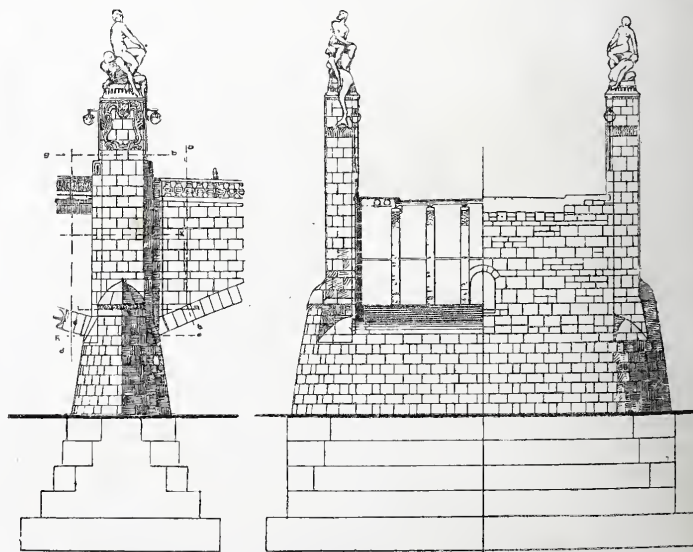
Strompfeiler. Längsansicht und Querschnitt mit Seitenansicht.
